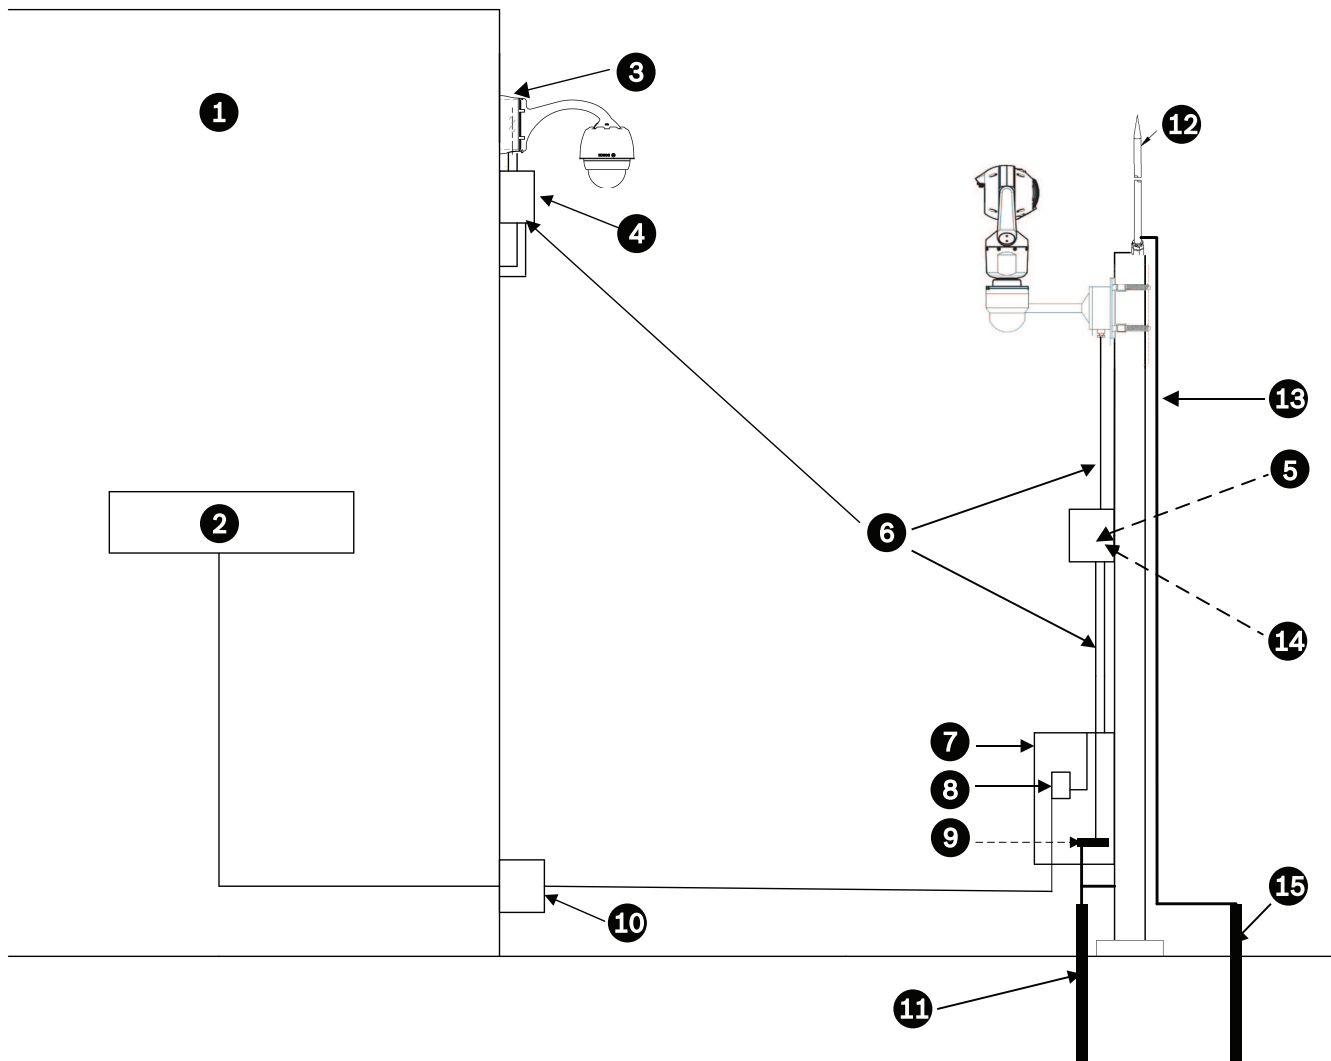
Corretta installazione all'esterno con corretta protezione da sovratensione/parafulmine
